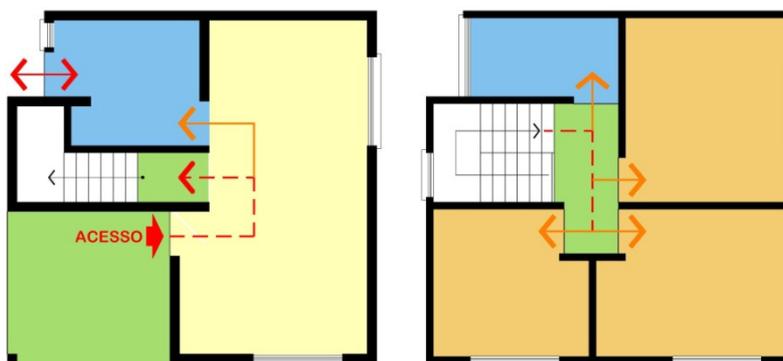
Planta esquemática com a setorização funcional e fluxos de circulação
